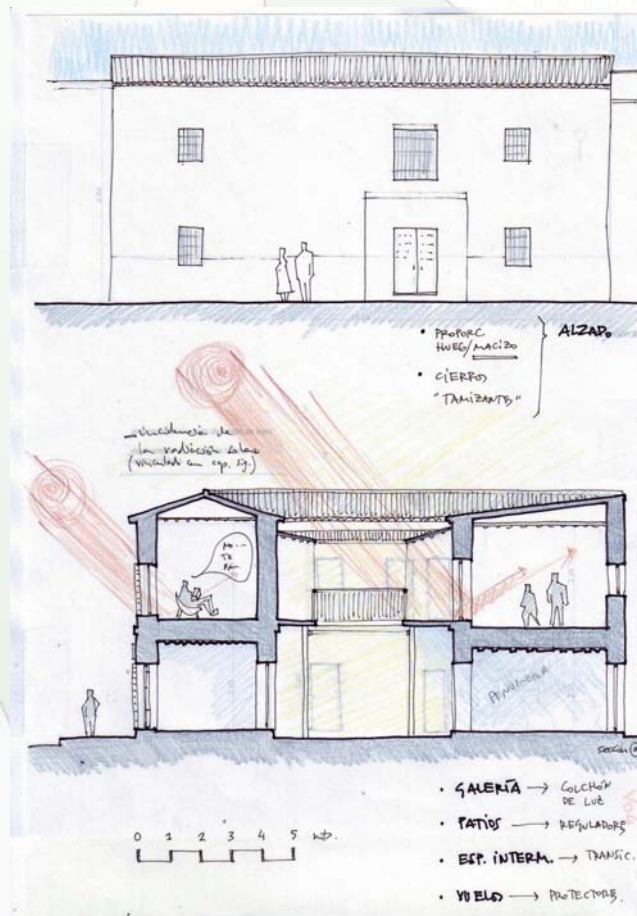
Equemas en alzado y sección de inmueble semi-público en Écija (Sevilla).
